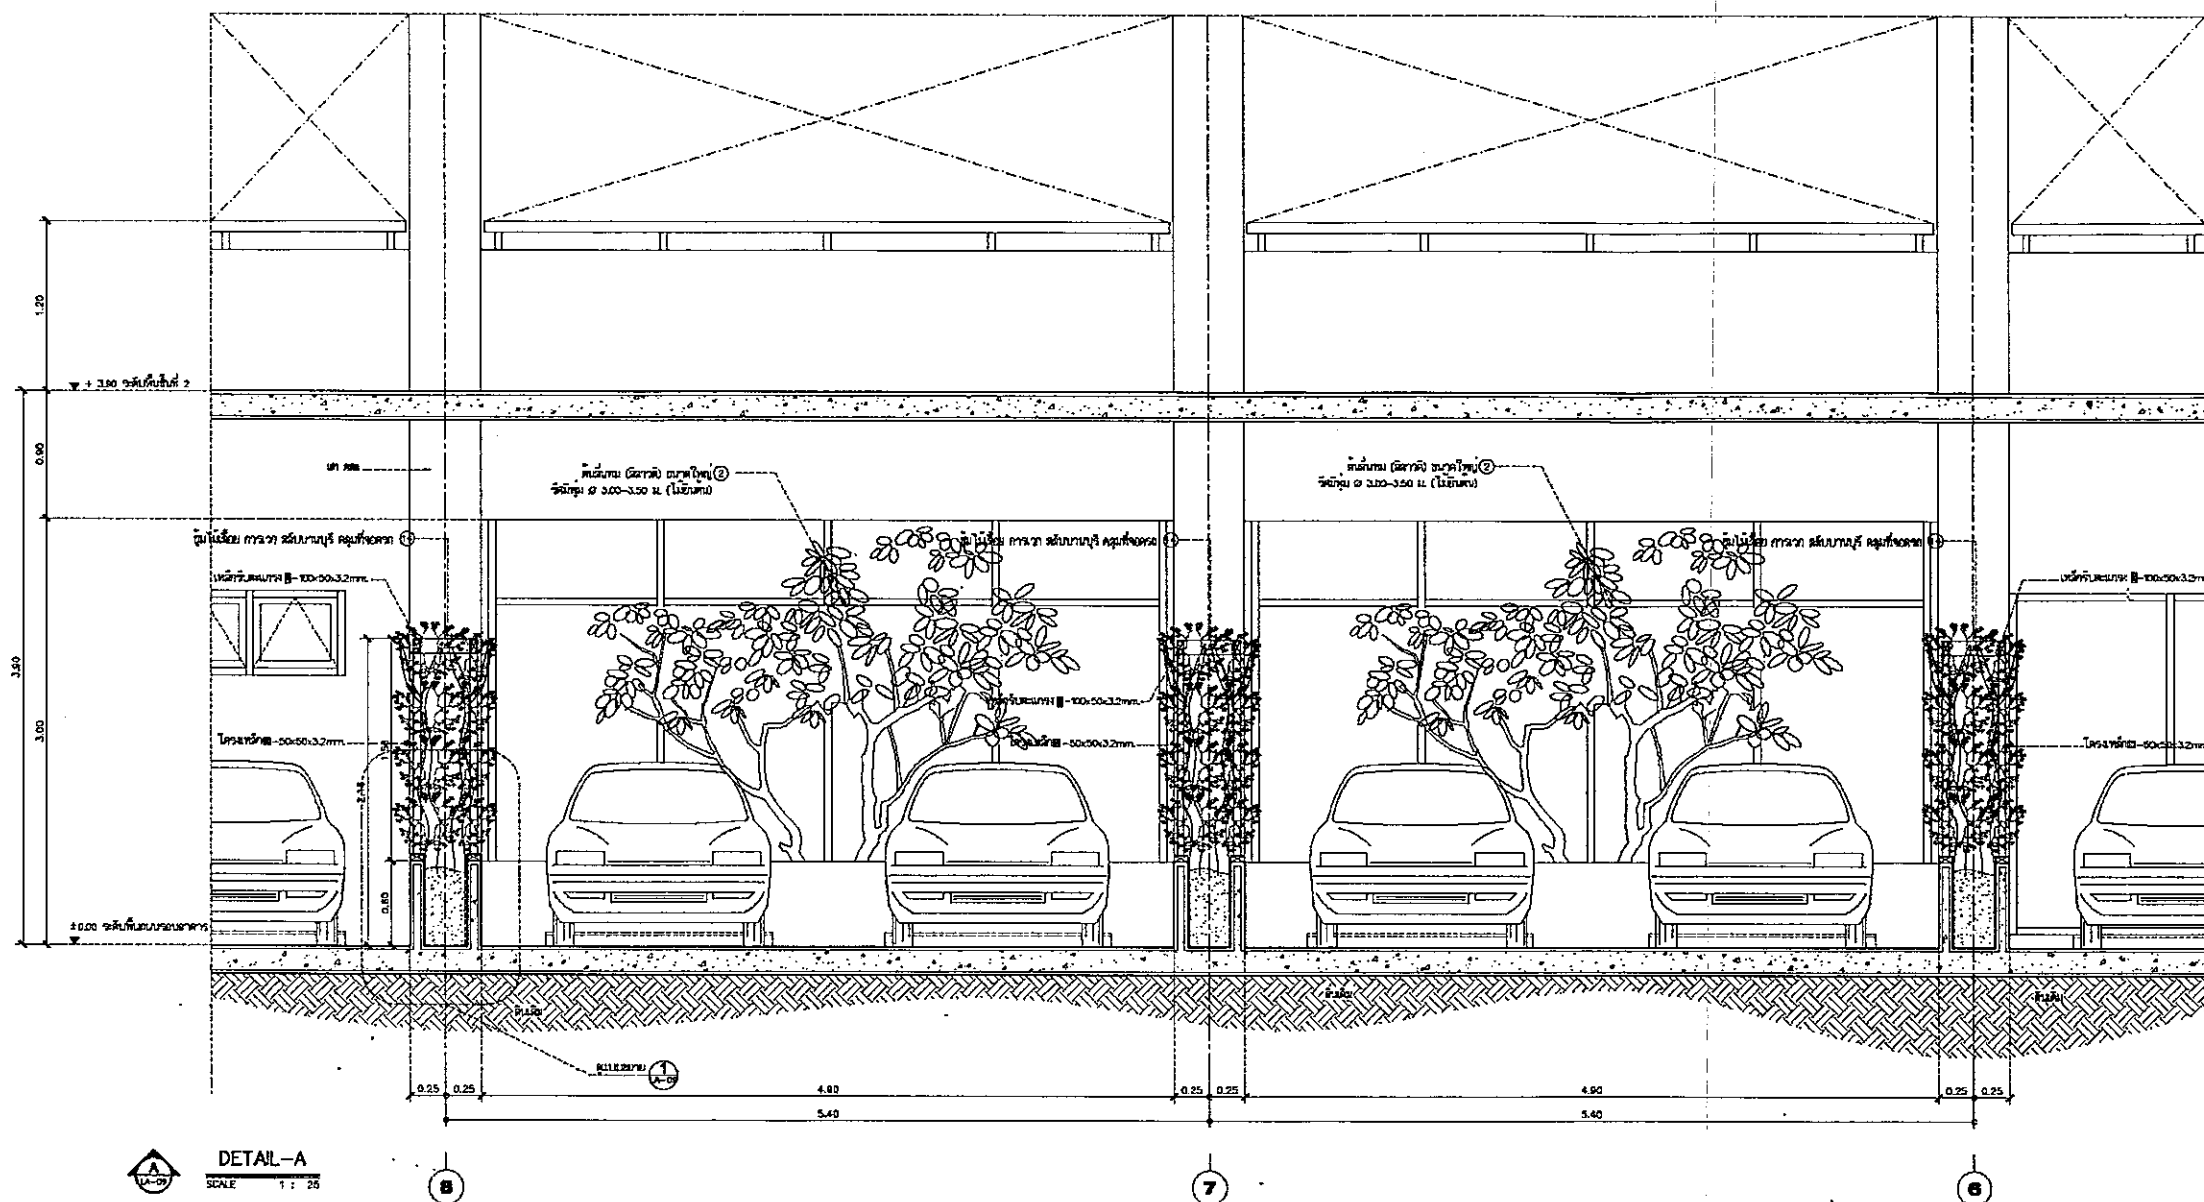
ผังแสดงรูปตัดการจัดภูมิสถาปัตย์ของโครงการ
